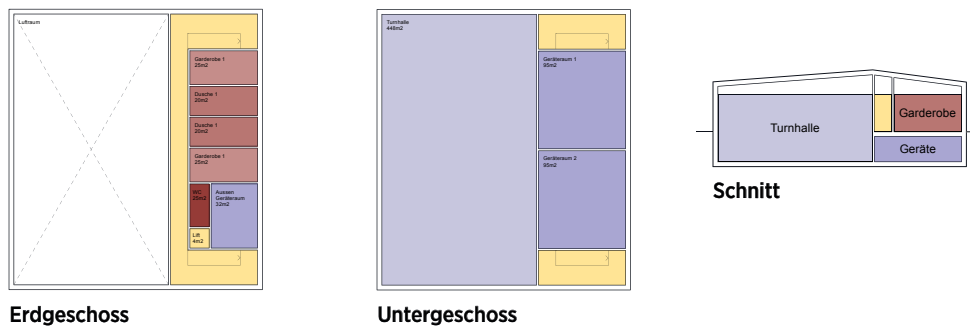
Grundriss Turnhalle Neubau (Bearbeitungsteam)
